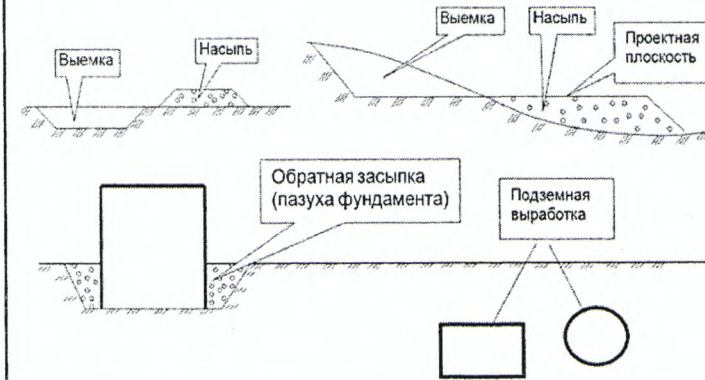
Выемки и насыпи, подземные выработки и обратные засыпки
